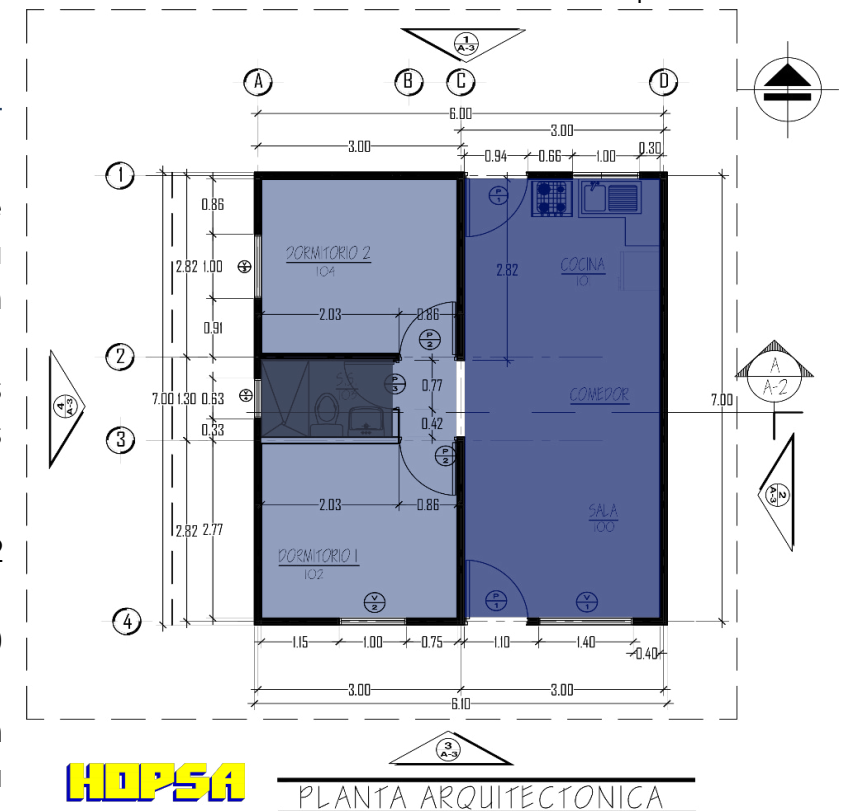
Planta Arquitectónica de Vivienda Valles de Sandino Fuente: HOPSA
